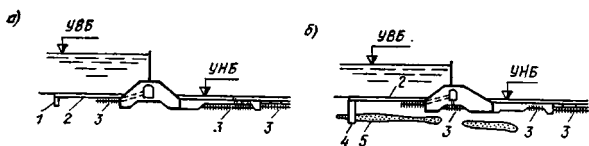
Схемы подземного контура на основании из связных грунтов
